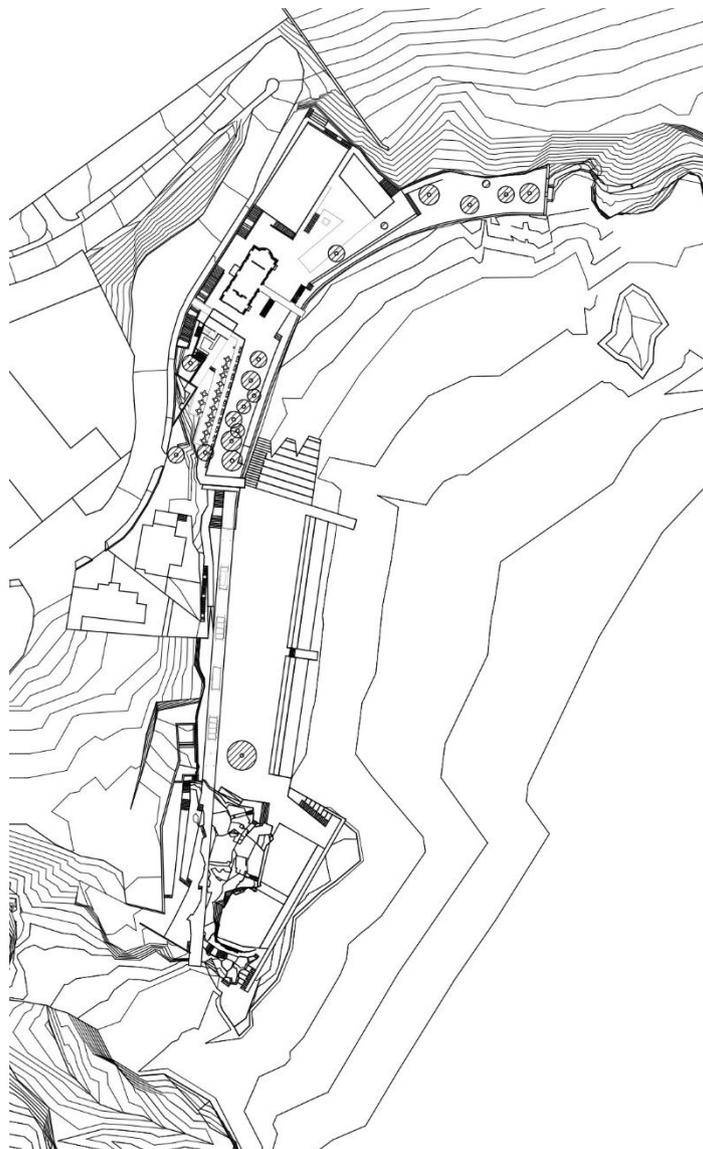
Planta de implantação da Quinta da Calaça, escala 1:2000
